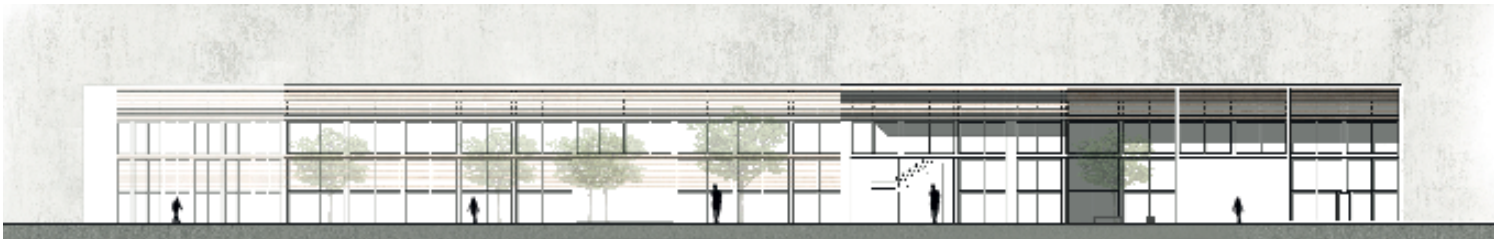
FACHADA OESTE (Elaboración Propia)
